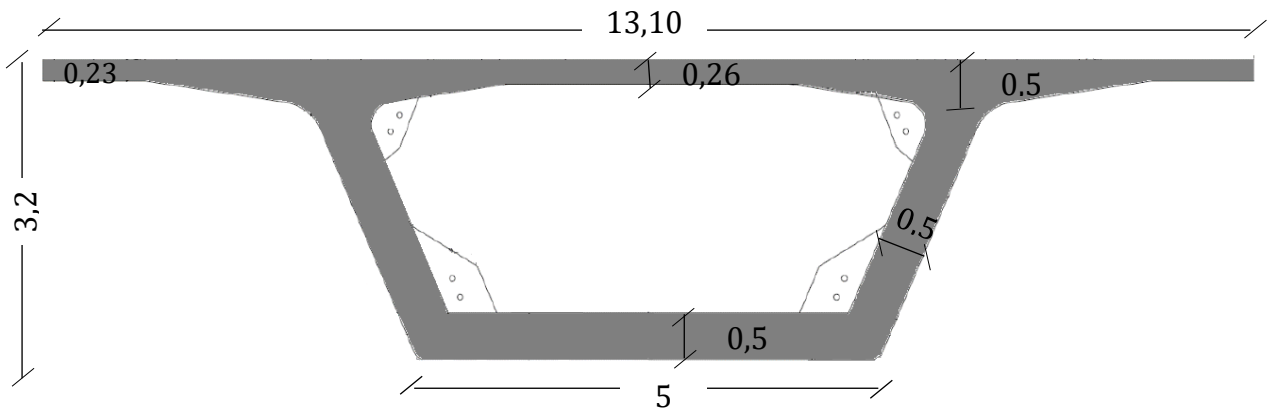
Coupe transversal (coupe 02) du voussoir V01
